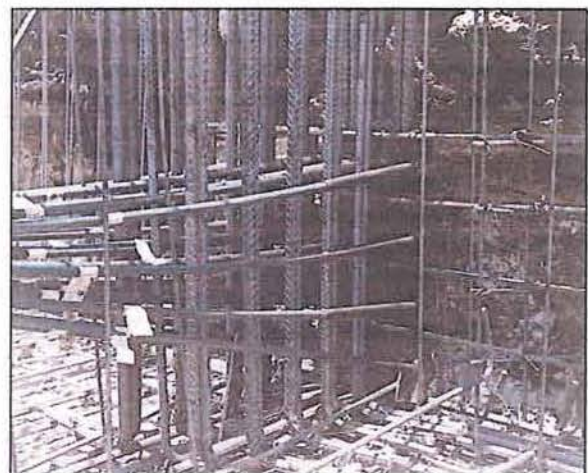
Anclajes (fijo) del tendón de preesfuerzo de las contratraves de cimentación.
